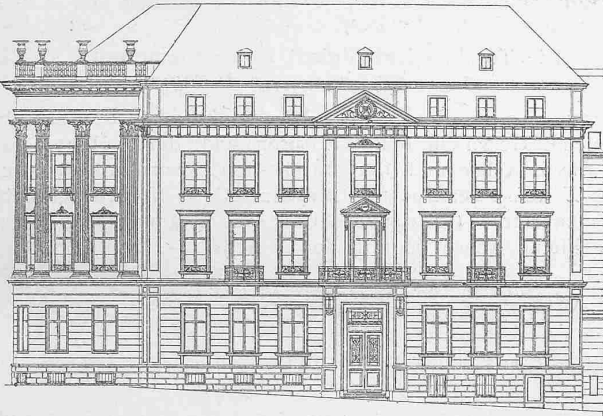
Die Handelsbank. Umgebaute Fassade gegen die Freie Strasse Masstab 1 : 400.
